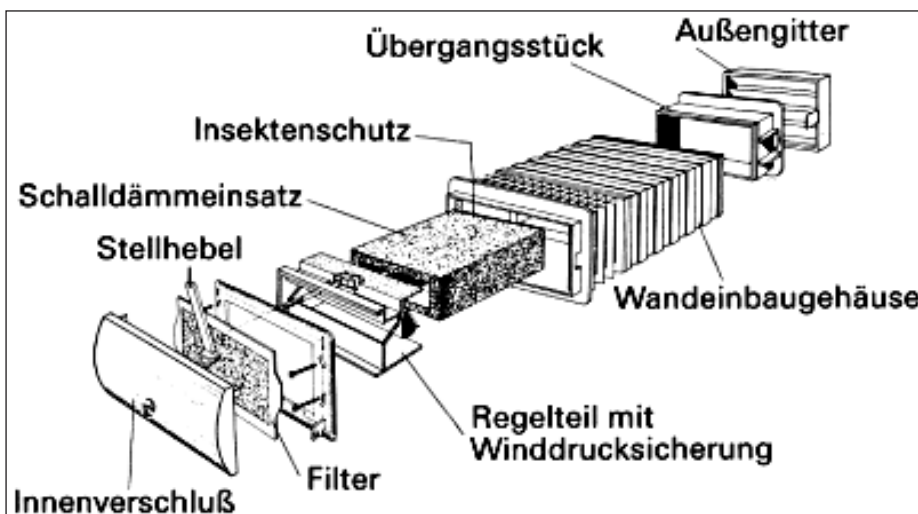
Detailzeichnung einer Nachströmöffnung für Montage in der Außenwand (rechts = außen) mit Schalldämmelementen, Insektenschutzgitter und Filter (linke Seite).
